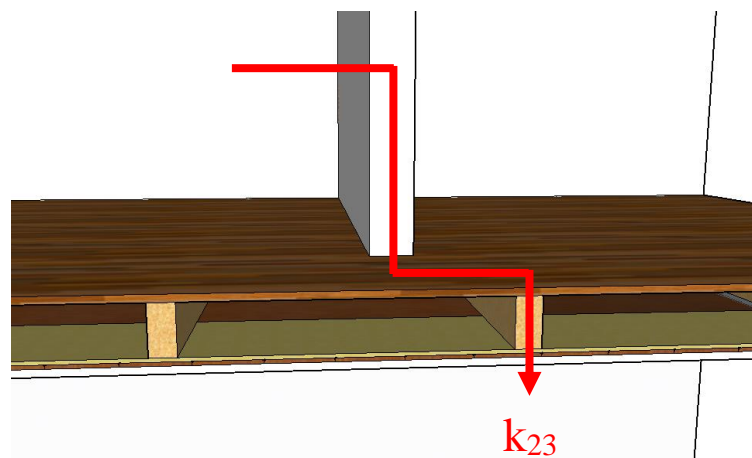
Pormenor construtivo da ligação entre a parede de tabique e o pavimento
